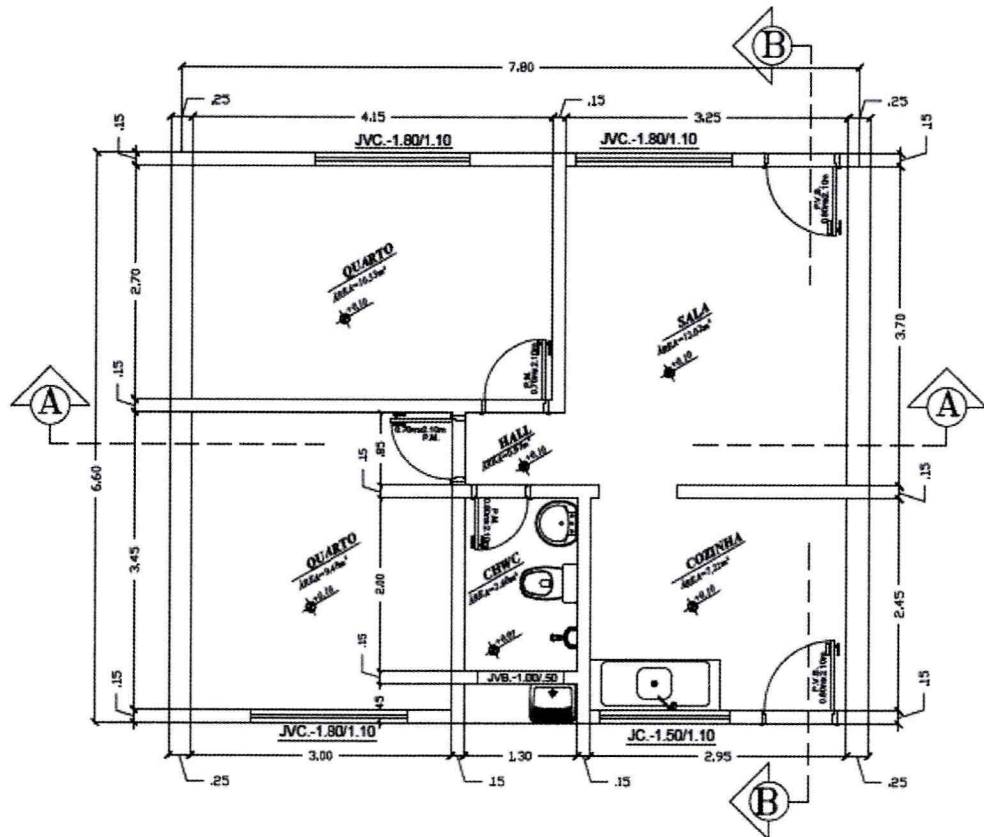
Planta baixa da habitação do estudo de caso.
